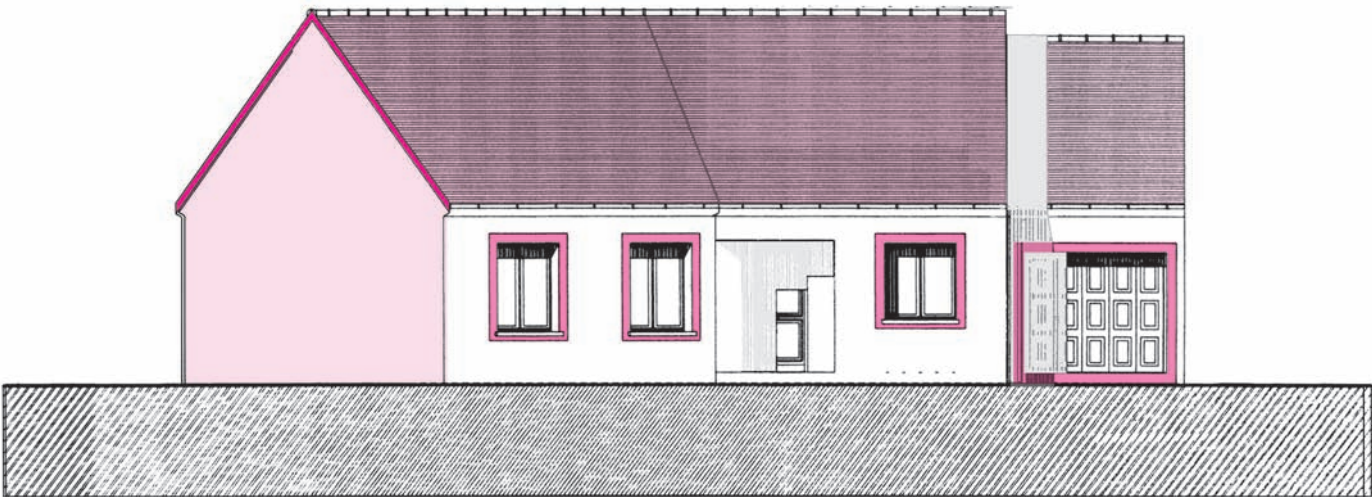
Façade principale avec le porche d'entrée et la porte de garage.
